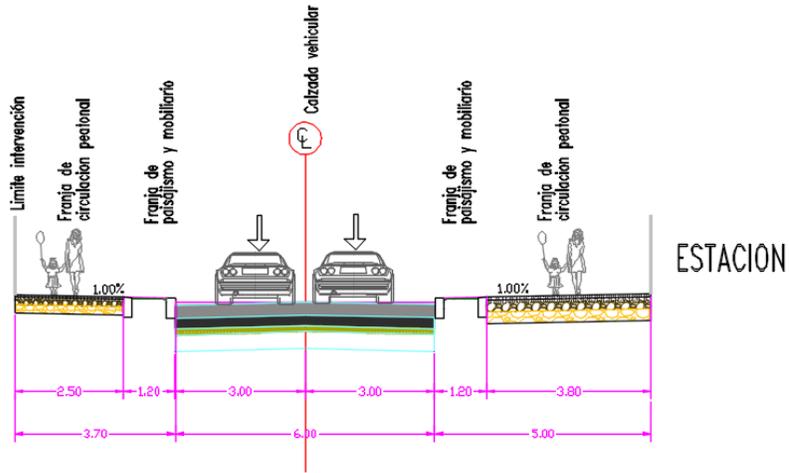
Planta Estación retorno Altamira (Alternativa 3)
